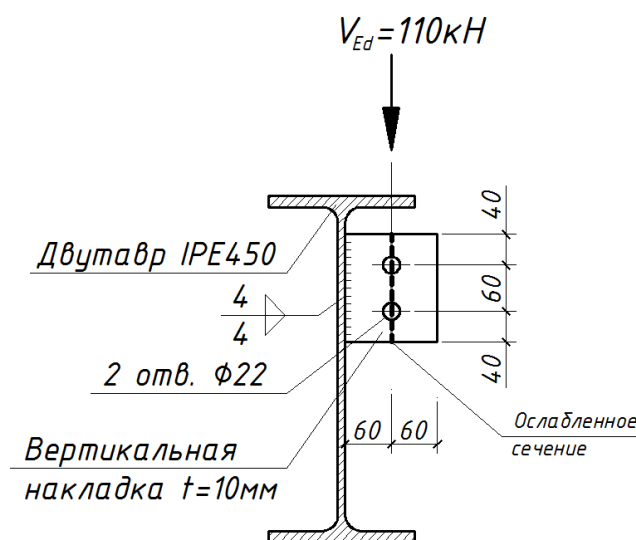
Узел крепления вертикальной накладки к основной балке
